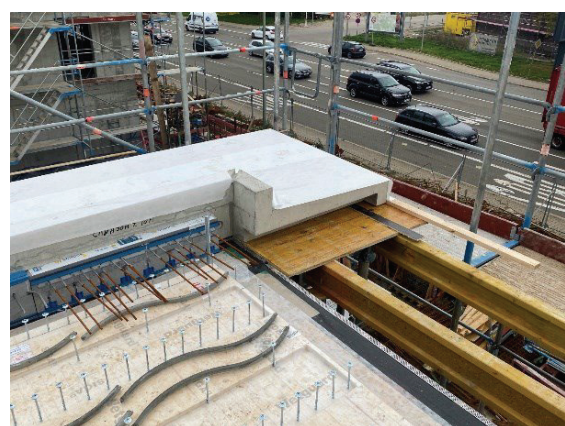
Beton-Krempe im Rohbauzustand, zusätzlich zu sehen sind die Iso-Körbe, welche die Verbindung zwischen HBV-Decke und Betonkrempe gewährleisten © P.W.S.
